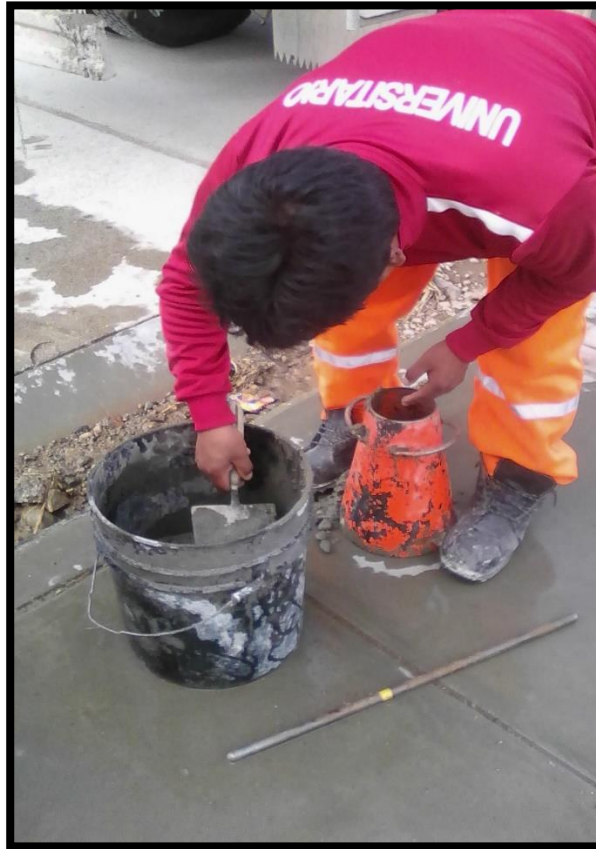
Puesta en obra del concreto premezclado en Carhuamayo.
